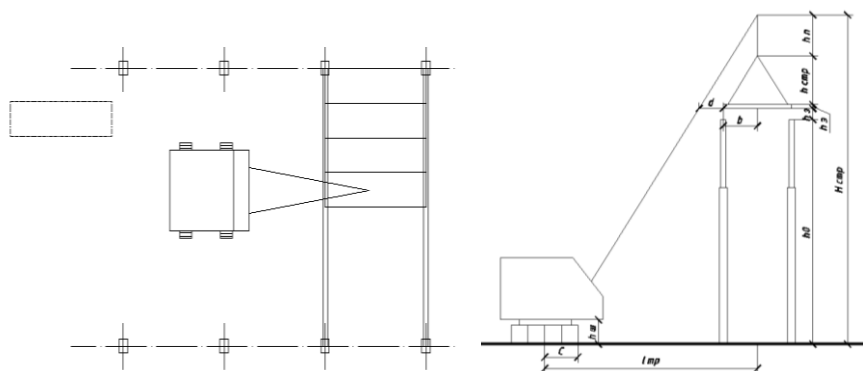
Схема для определения технических параметров крана для монтажа плиты покрытия
